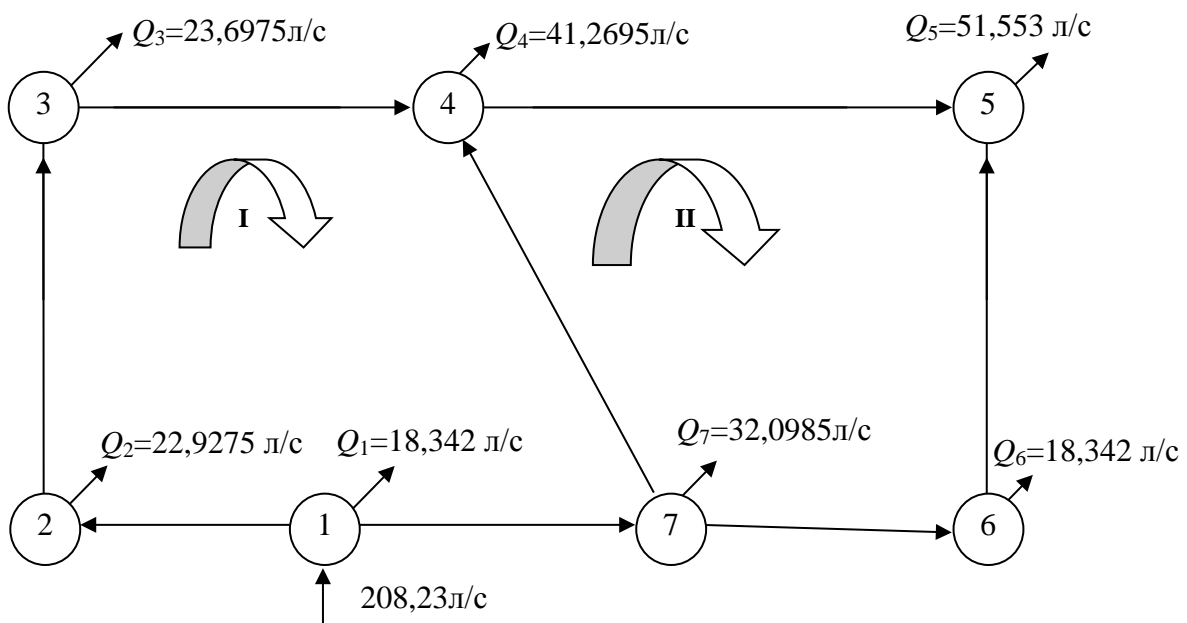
Расчетная схема водопроводной сети с узловыми расходами
